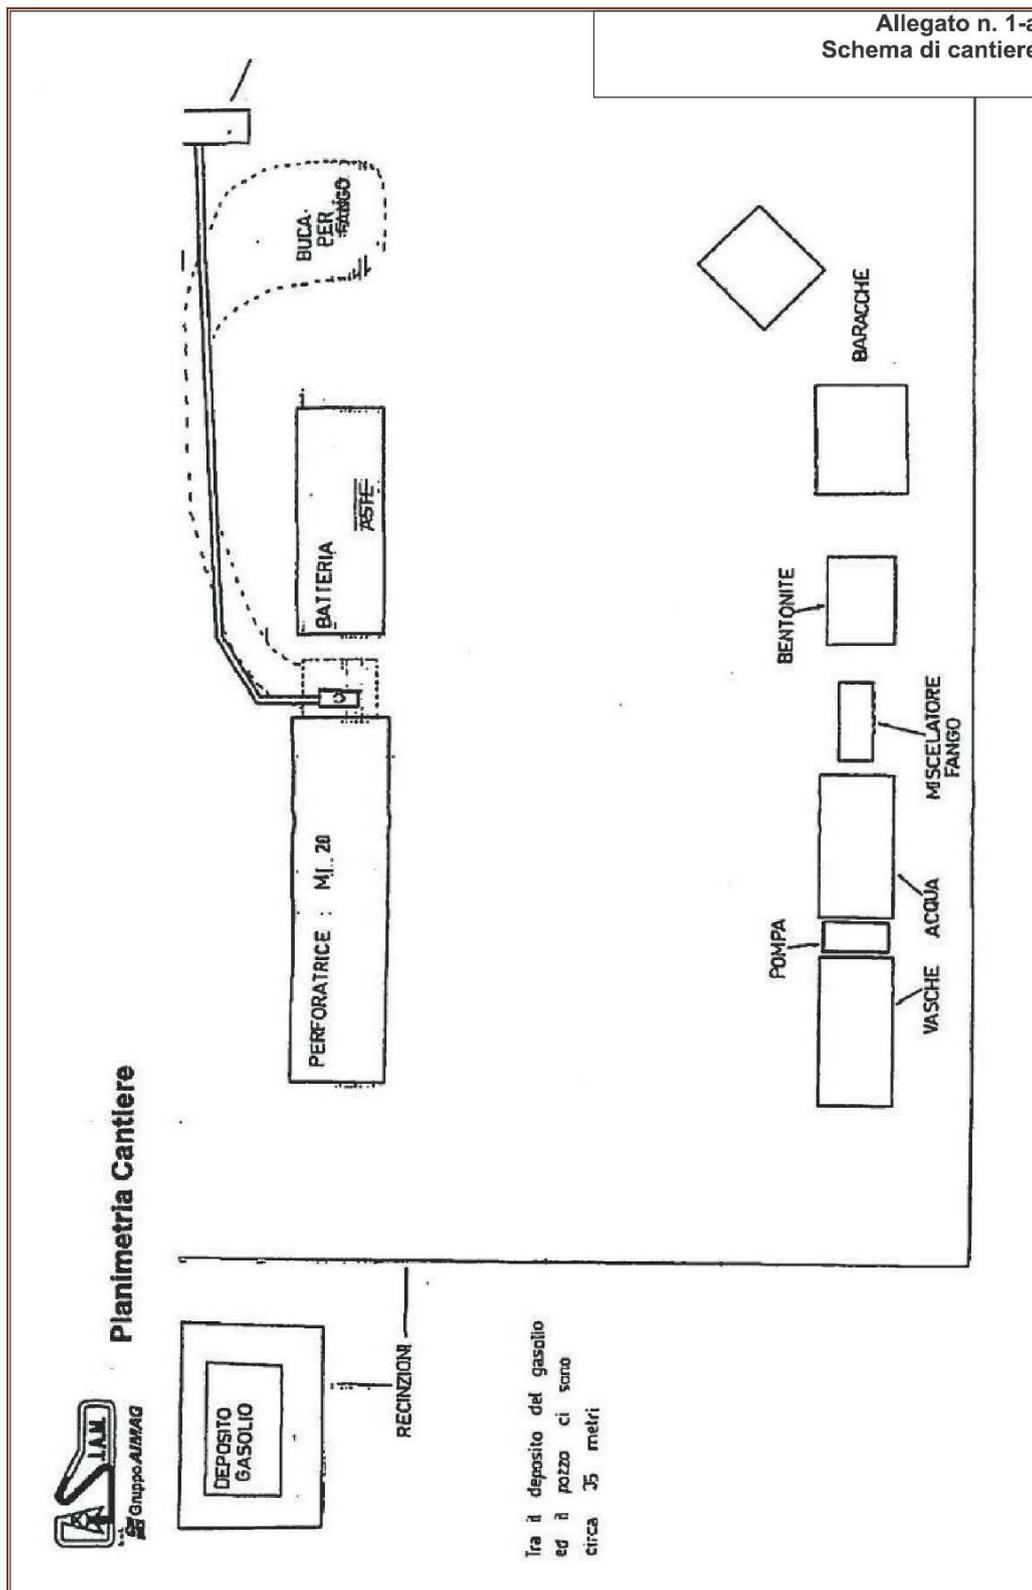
Schema Cantiere tipo di perforazione di un pozzo.
